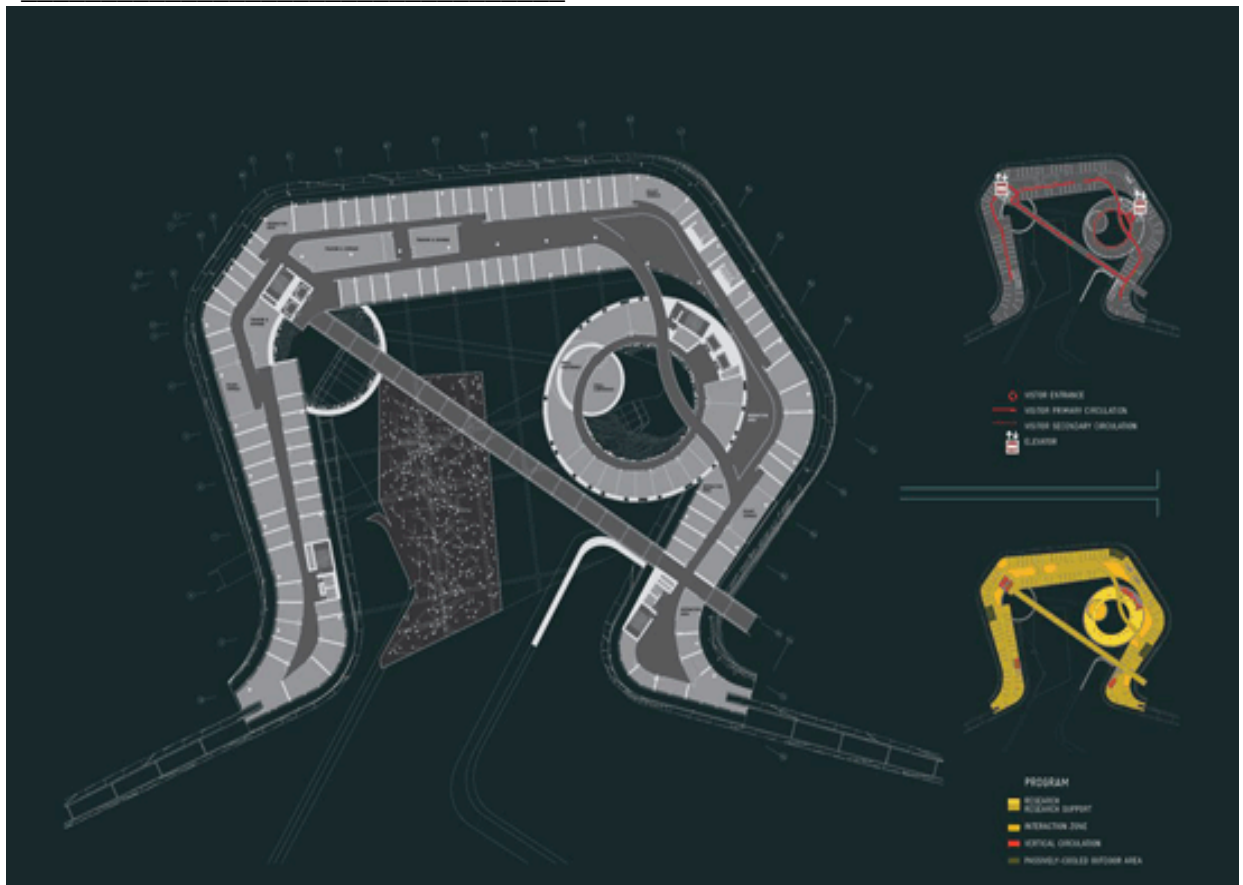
Le plan du 1^{er} étage de l'exemple 03
